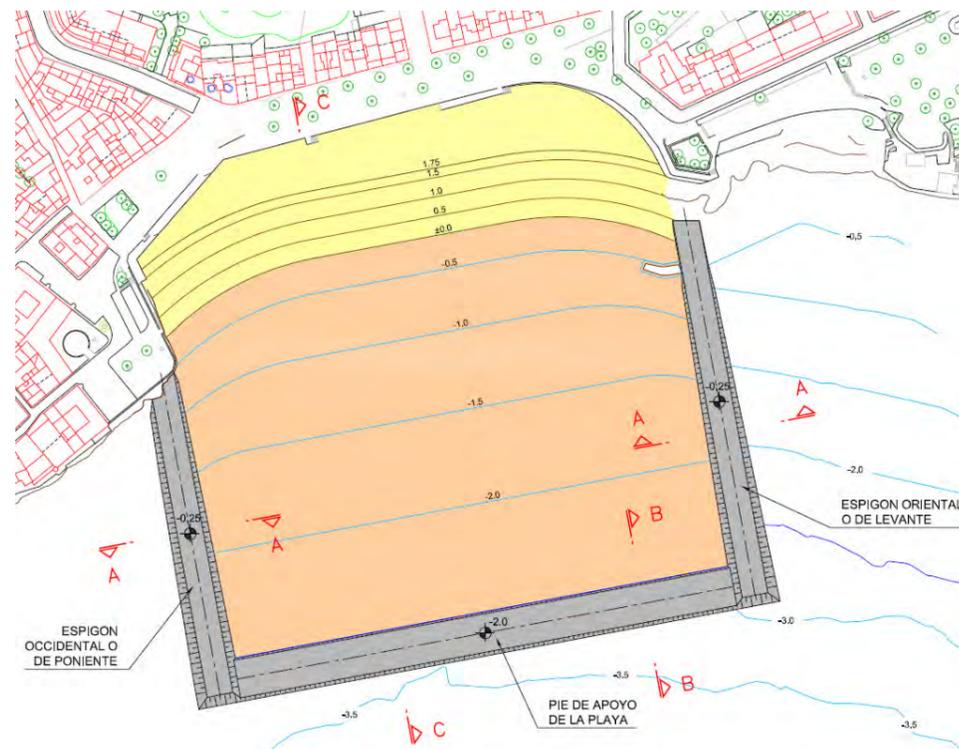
Planta de la Alternativa 4. (Fuente: Elaboración propia)
